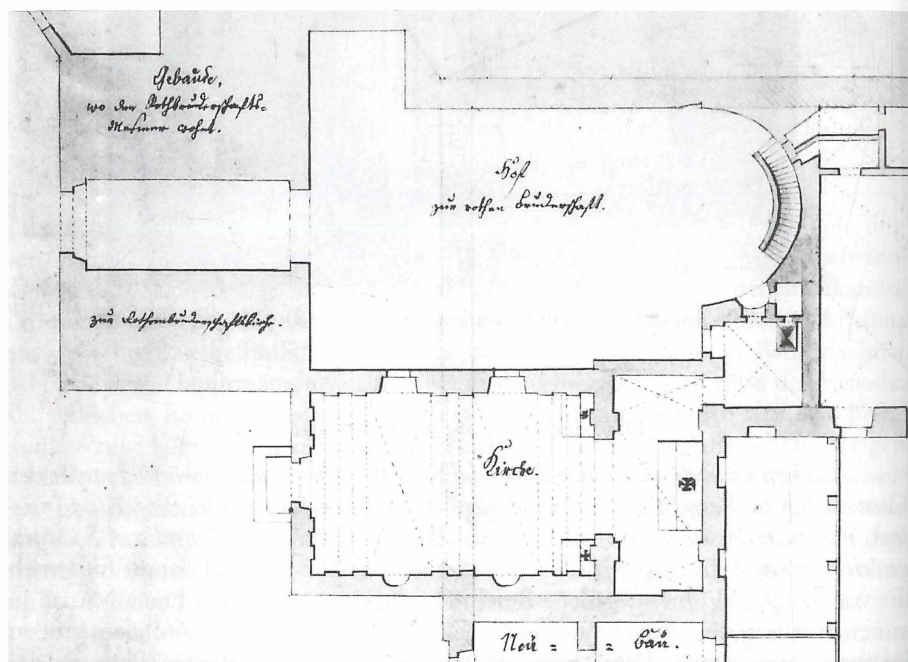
Grundriß der Salvatorkirche in der Kaigasse in Salzburg um 1800. Planzeichnung undatiert und unsigniert. SLA, Karten und Risse I21.
